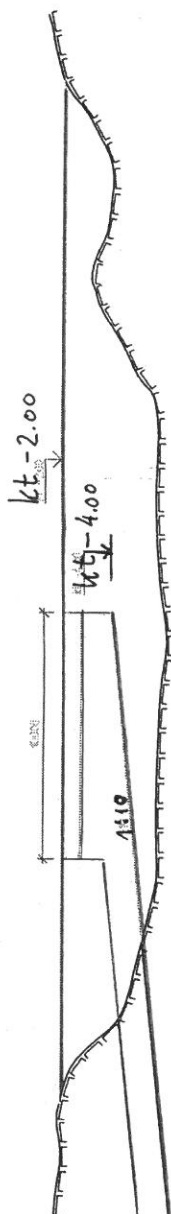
Oversikt over inntaksalternativ. Alt 2b gir større fallhøyde H_b
